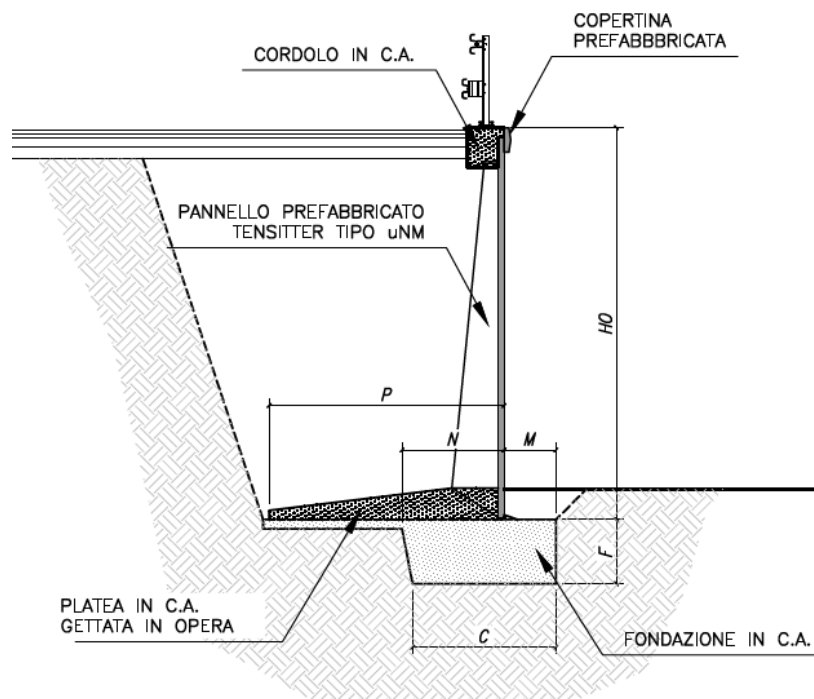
Sezione tipologica muro prefabbricato di tipo "uNM"
